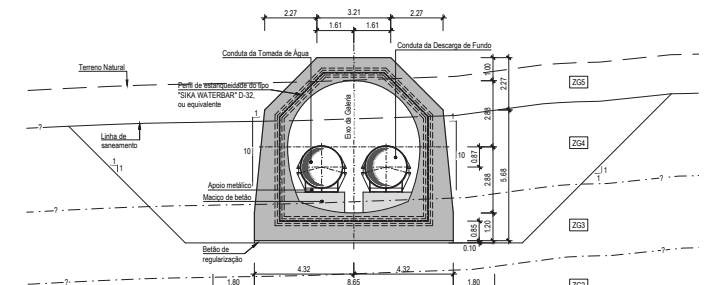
Secção Transversal da galeria de Tomada de água e Descarga de Fundo. Water Intake and Bottom Outlet Gallery.
